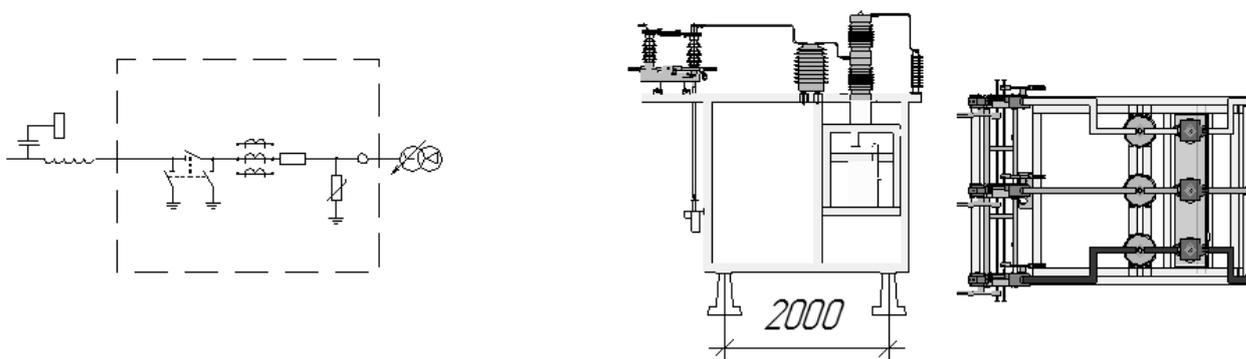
Схема 35-3 и внешний вид блока Б35\_1-425.
